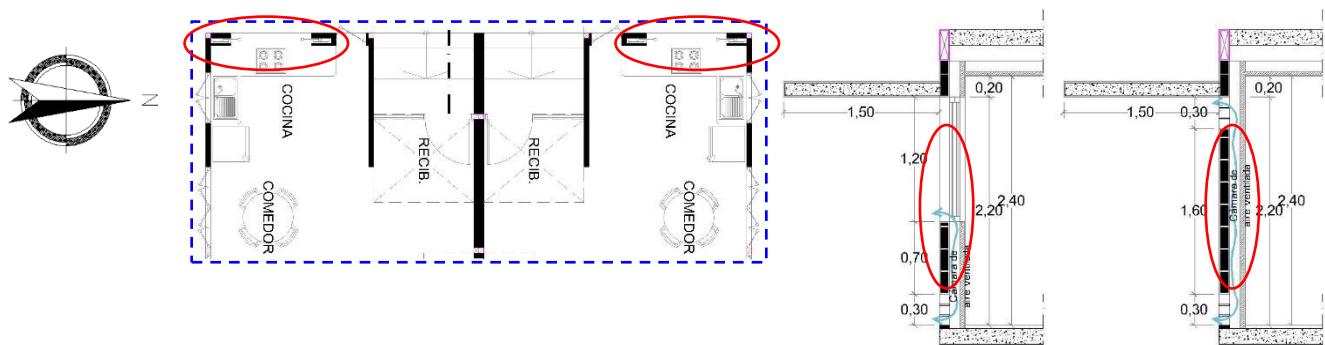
Murosoeste en planta baja y Cortes de los muros dobles ventilados en orientaciones este y oeste para ventanas de 1.20 m y 2,20 Elaboración Propia
